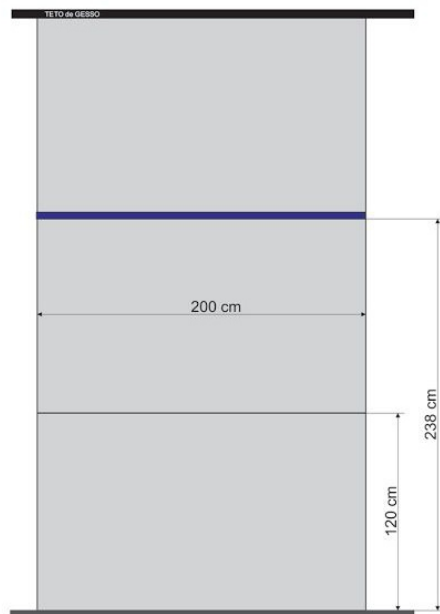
(cont.): Detalhamento da planta da sala Mutações [figura 4 de 4]
